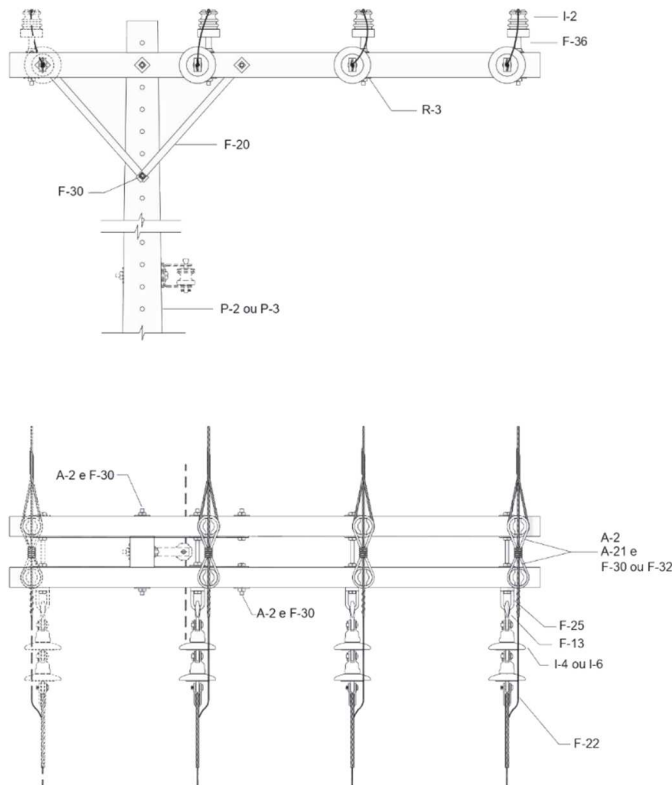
Primário – Estrutura M3-2 – Poste de concreto de seção circular – Cruzeta de 2 400 mm
